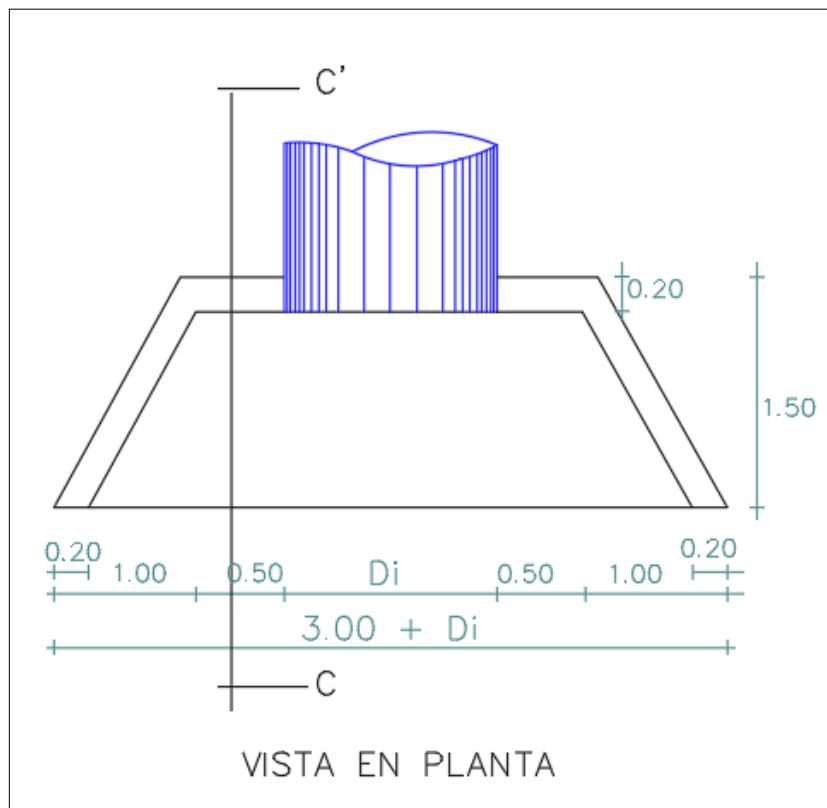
Tipo 2: Cabezal de Descarga y Muros de Ala (Vista en Planta).
